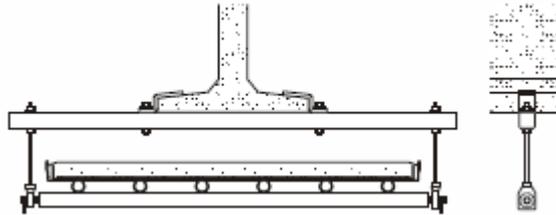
Exemple de suspension au moyen de supports rigides avec rouleaux coulissants pour panneaux suspendus parallèlement aux poutres
